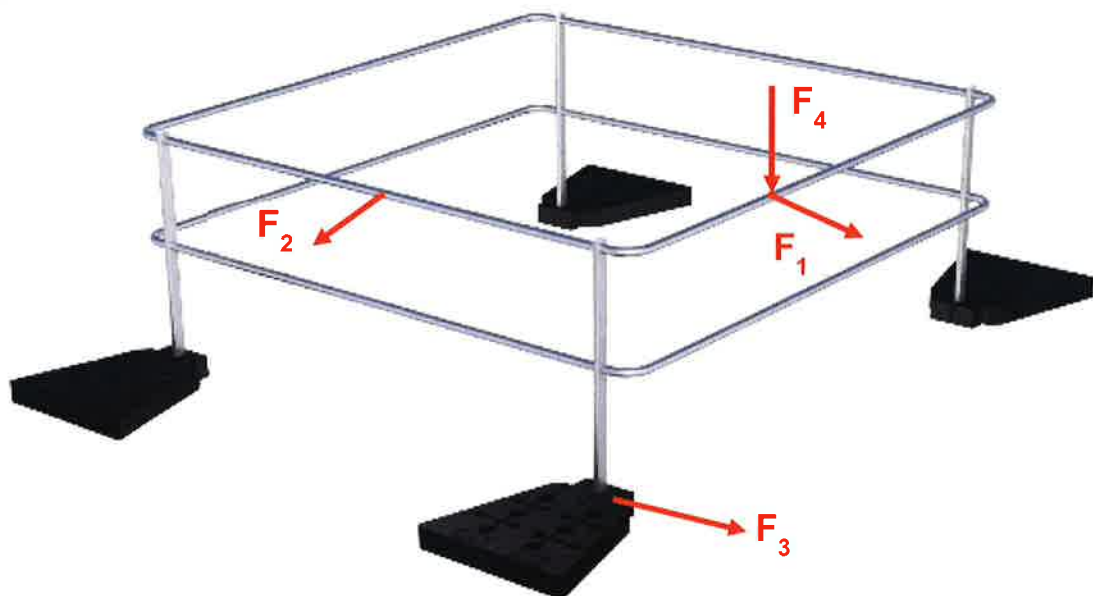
Prüfaufbau 5 mit den Richtungen und den Positionen der Kräfteinleitungen
